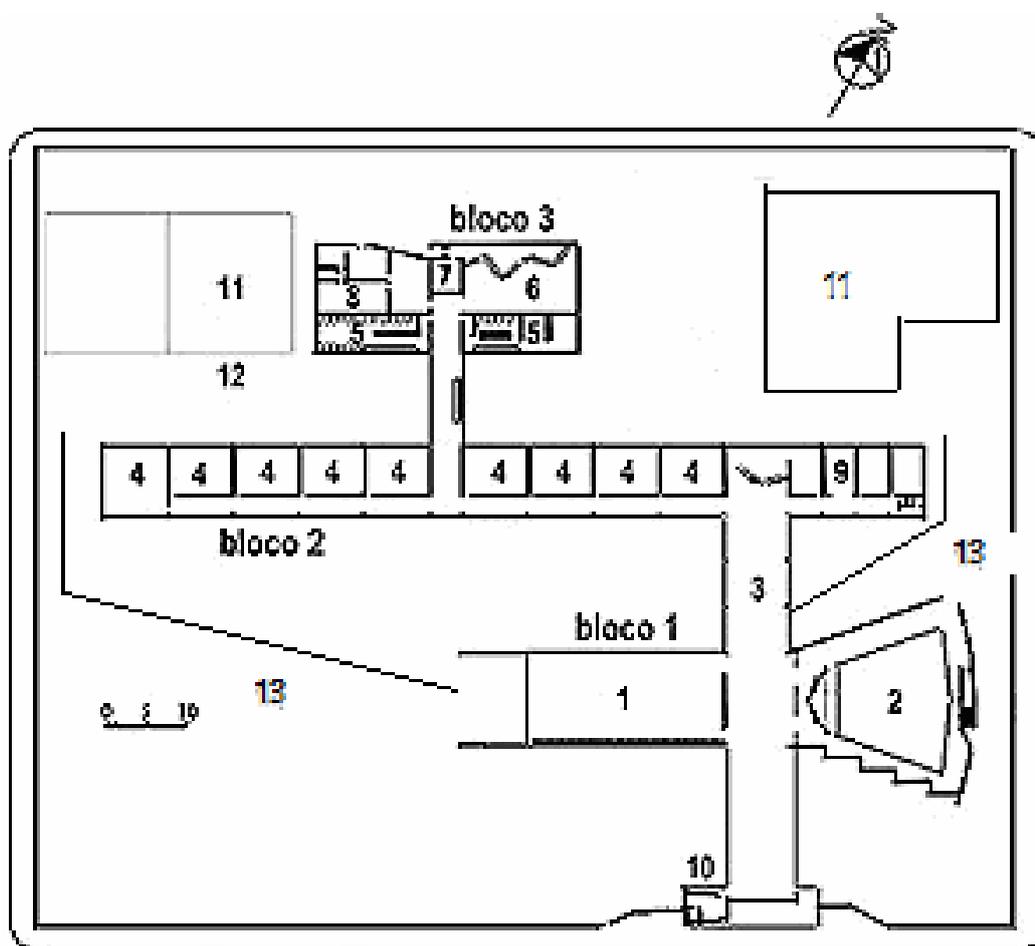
Planta baixa esquemática da Escola Maria Constança Barros Machado (Arquivo da Escola MCBM)
